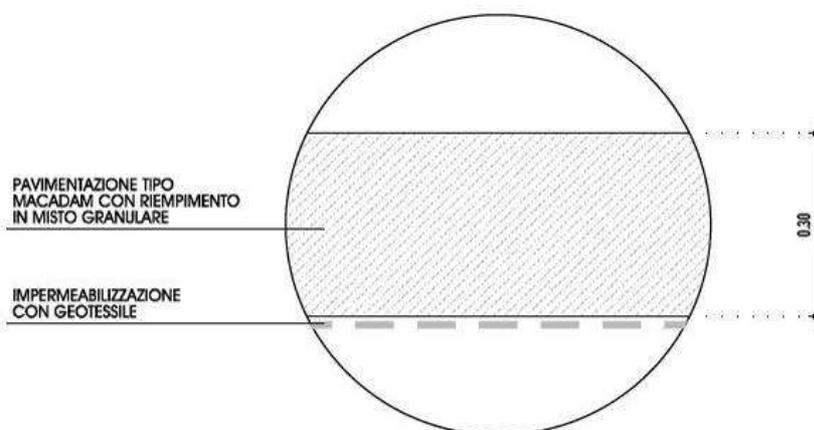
Stratigrafica pacchetto stradale pista di servizio
